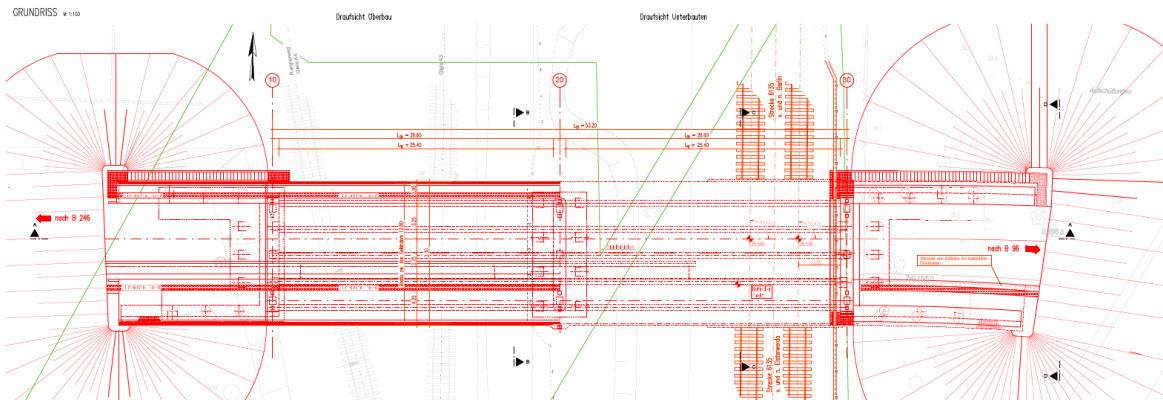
Brückenbauwerk technische Planung (skaliert)
